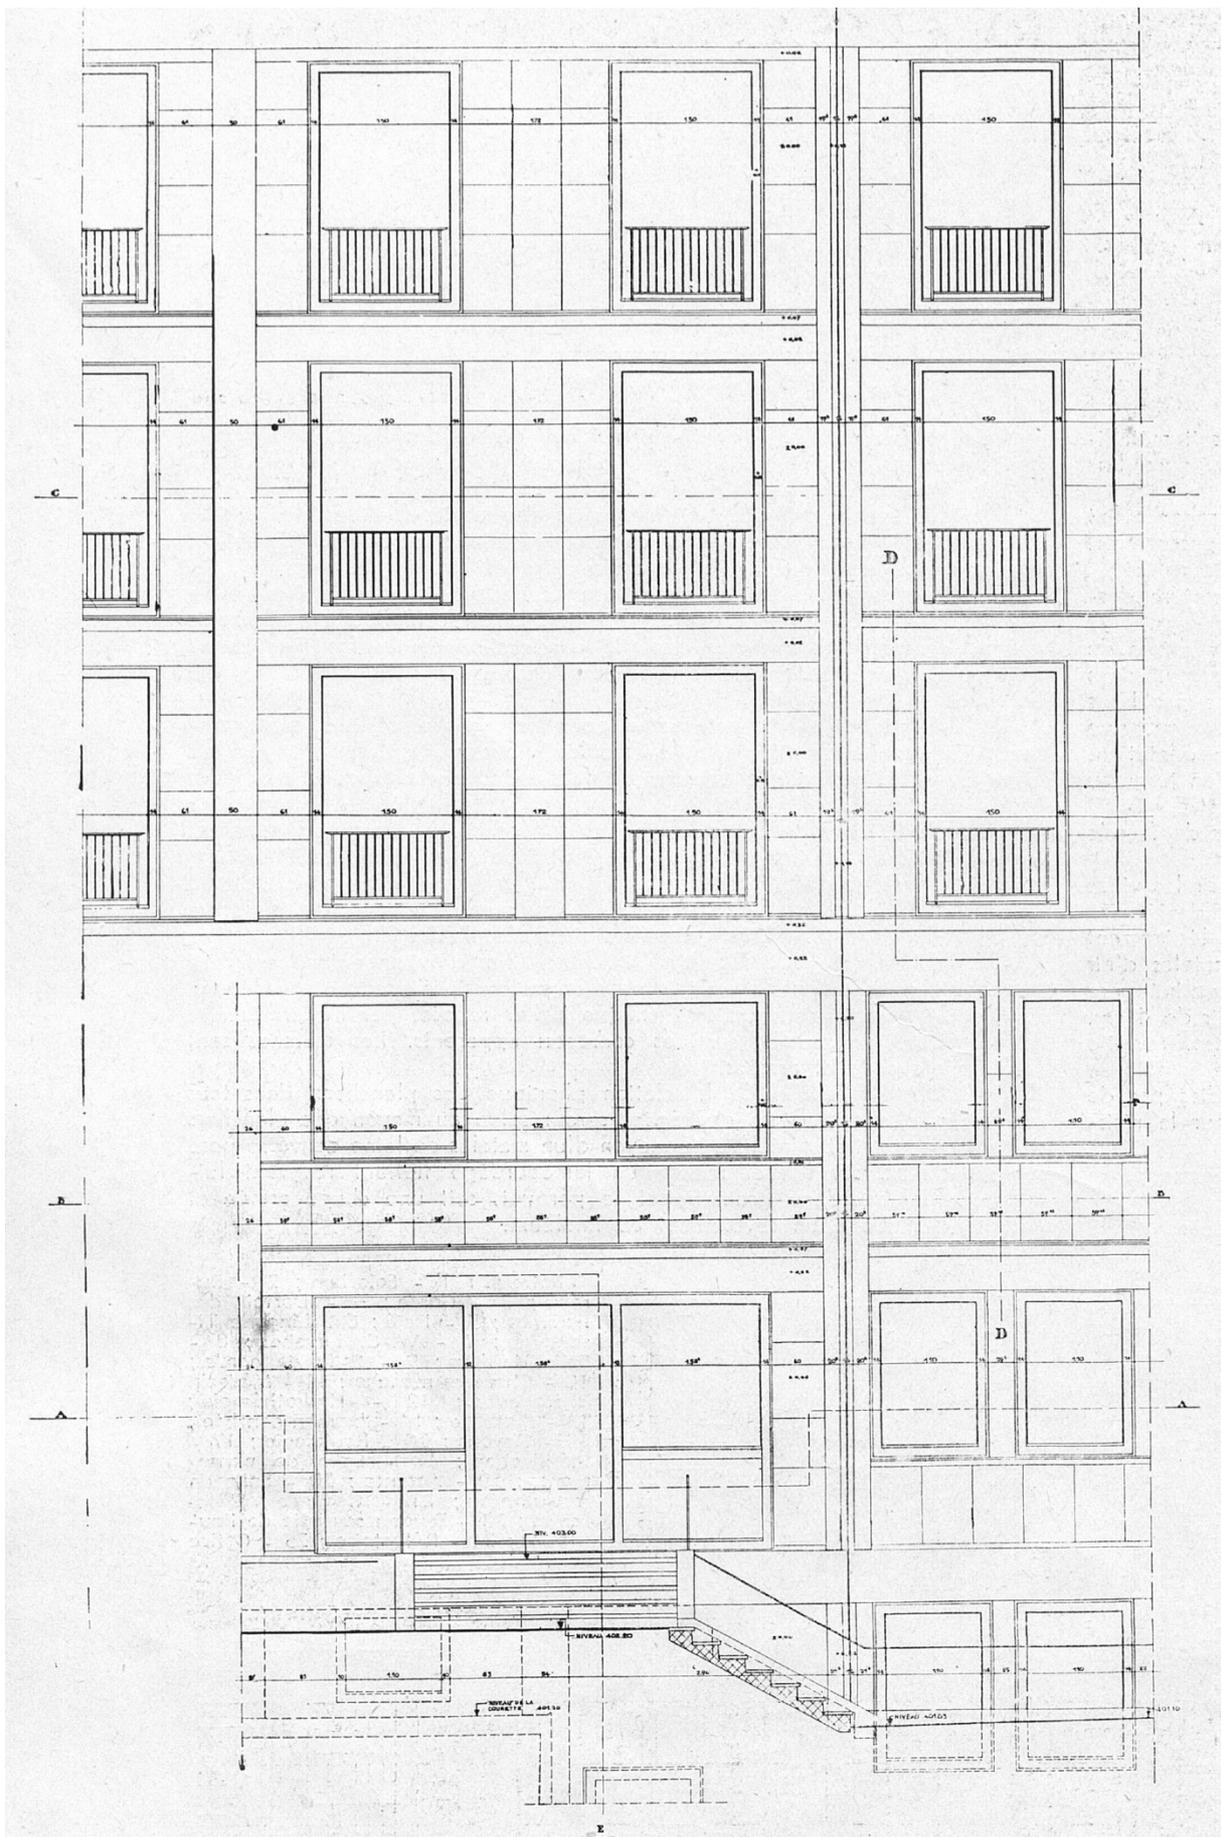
Détail constructif de façade publié dans la revue *Techniques et Architecture* en 1949.
